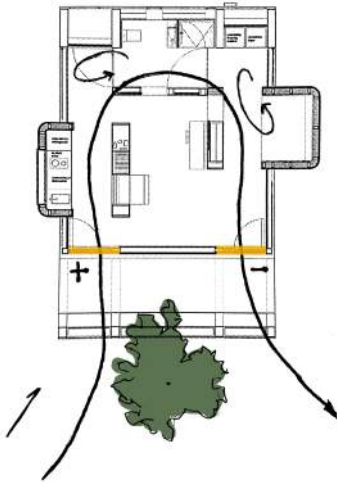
Caso III: aberturas en la misma fachada. Vegetación.
